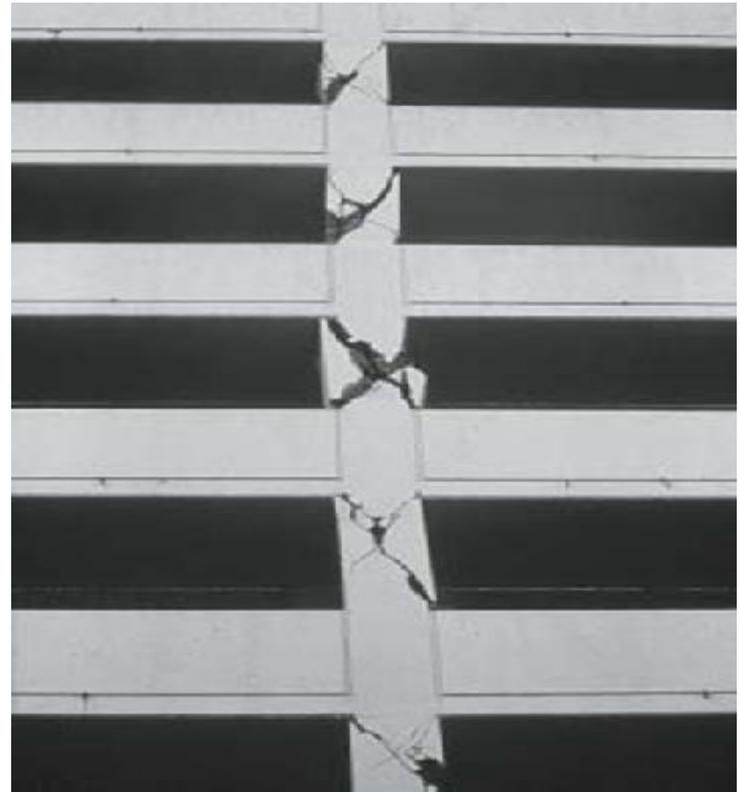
Destruction des poteaux à cause du fonctionnement en « poteaux courts »
